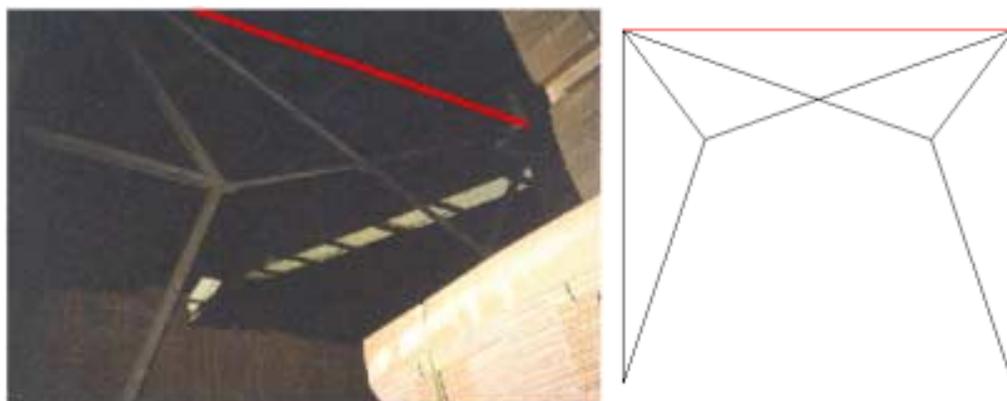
Falha de concepção - ausência de um elemento do contraventamento em "K" (em vermelho)
